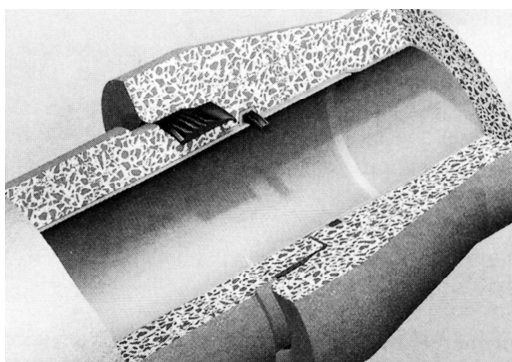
Разрез по соединению бетонной трубы с внутренней трубой из жесткого поливинилхлорида (система Фабекун).
